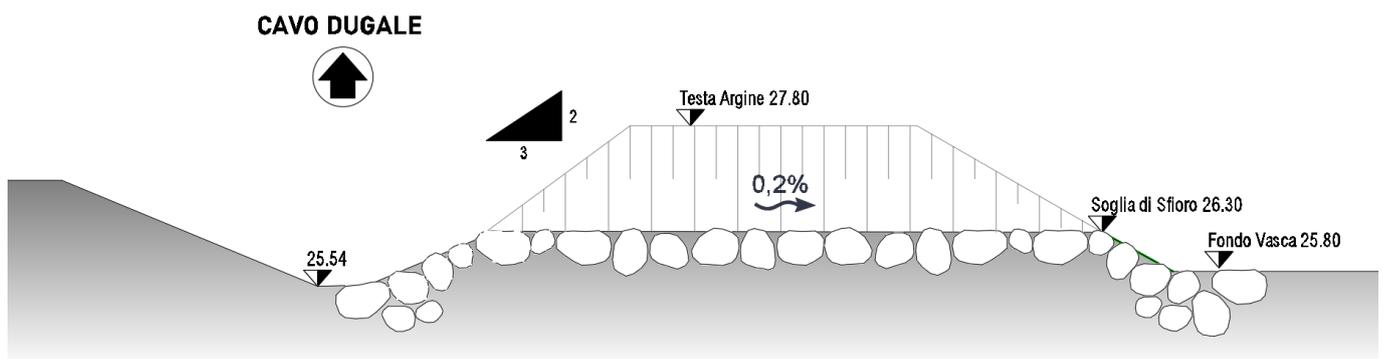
Manufatto di ingresso al bacino di laminazione: sezione trasversale – Cavo Dugale
